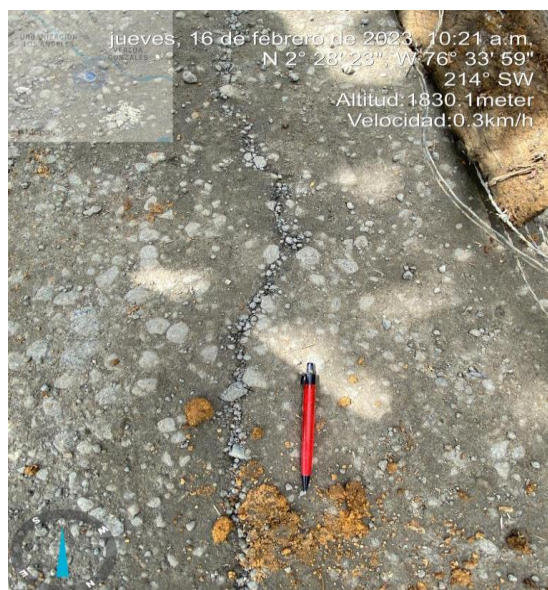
Grieta sobre la vía de acceso a la Vereda El Paraíso.
